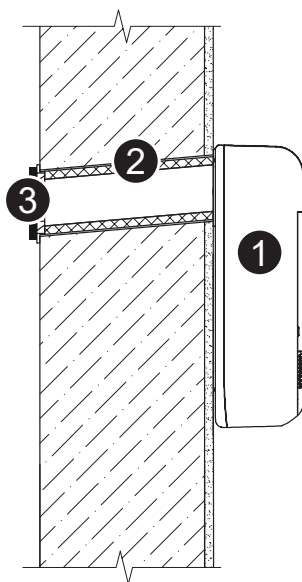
Крепление на железобетонные и кирпичные стены
